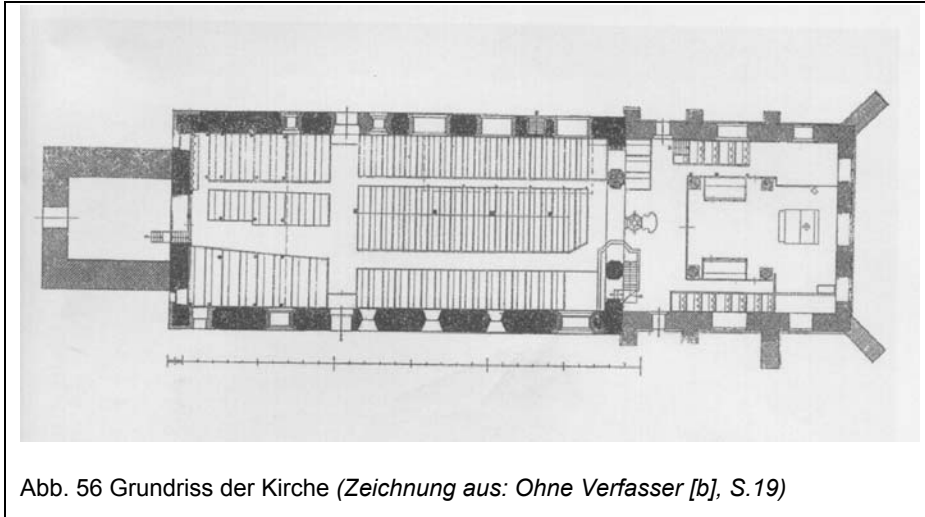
Grundriss der Kirche (Zeichnung aus: Ohne Verfasser [b], S.19)
